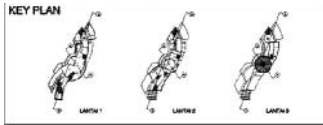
Denah bangunan dan zoning berdasarkan sifat ruang.
